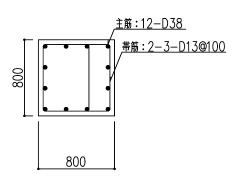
柱の配筋図(地下2階, X6a/YP通り, 柱頭部)(単位:mm)
